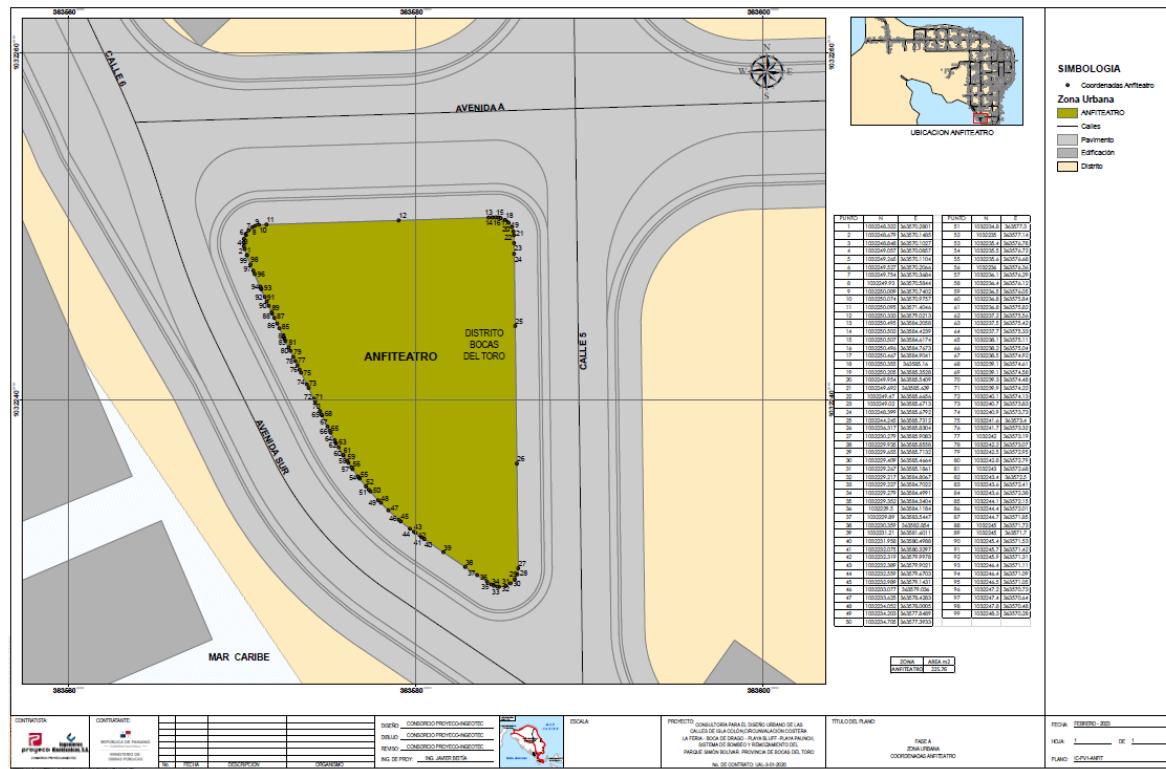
Plano de anfiteatro con coordenadas UTM (Anexo 09).
